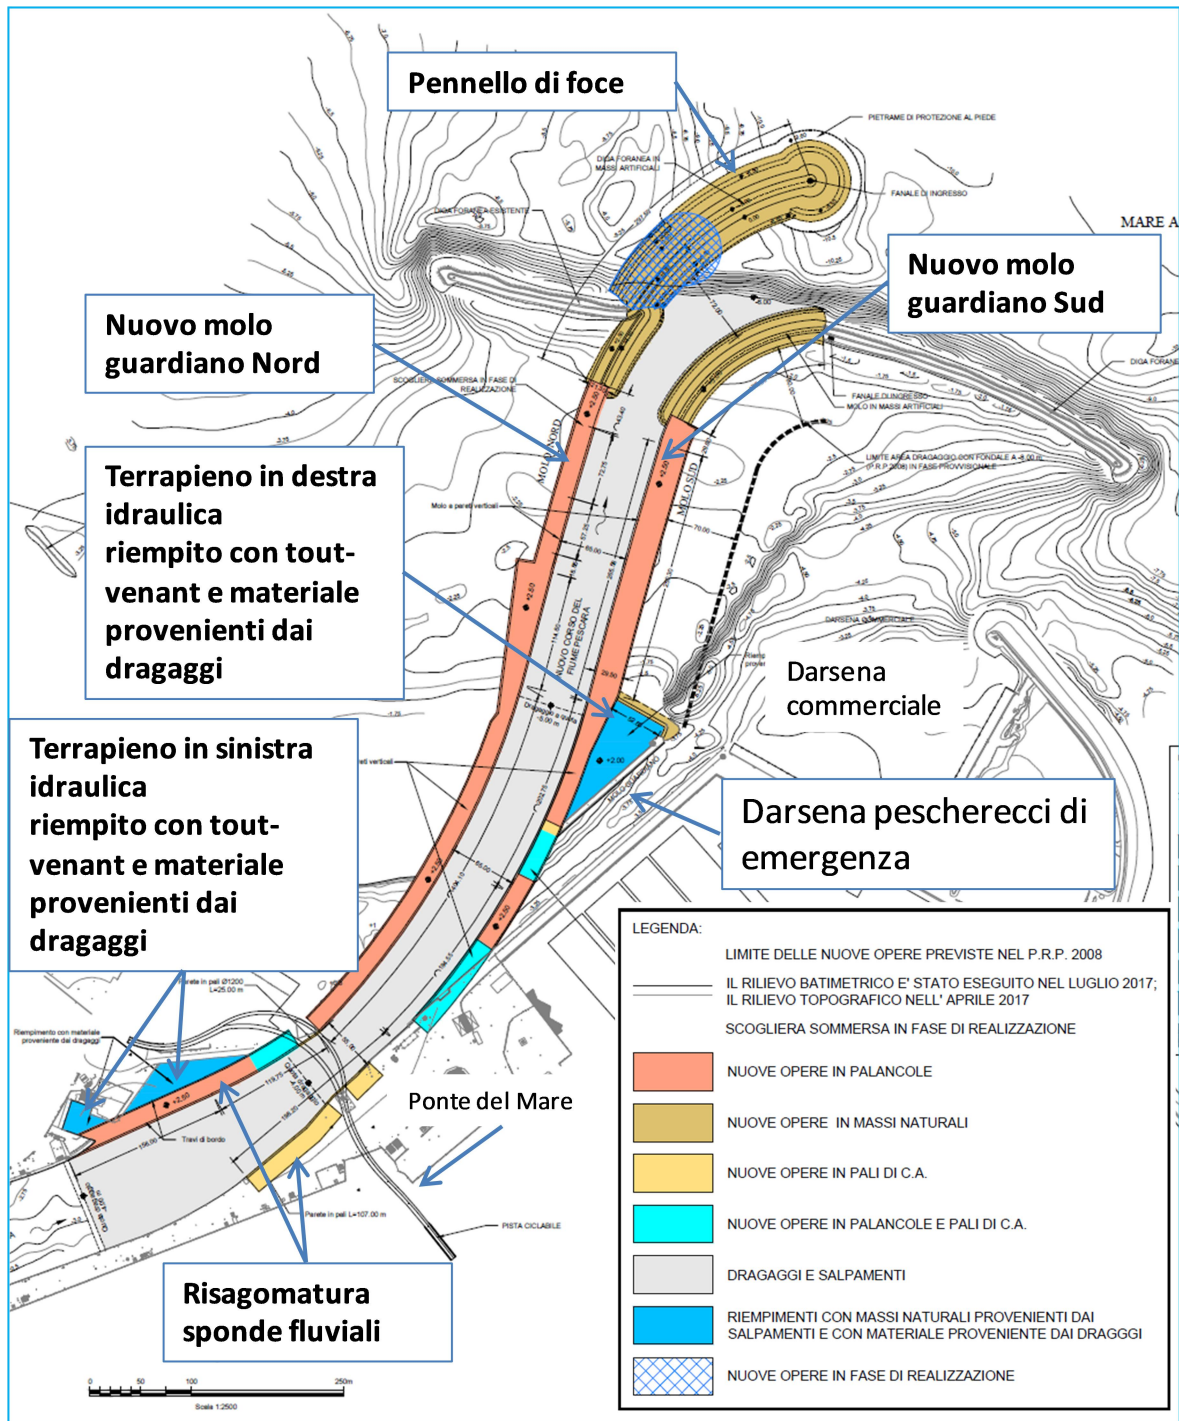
PLANIMETRIA DELLE OPERE IN PROGETTO
